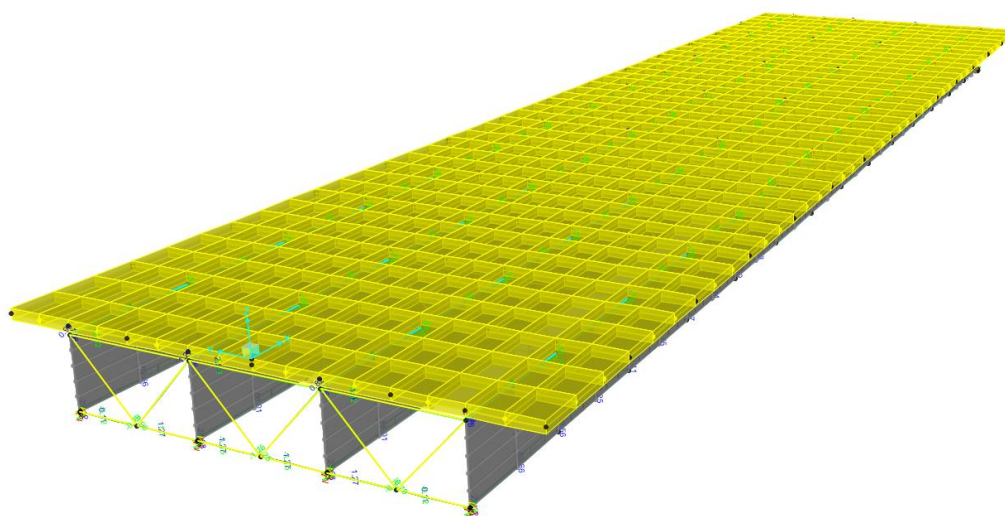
Modelo estructural de la superestructura del puente. Fuente: Elaboración propia.
